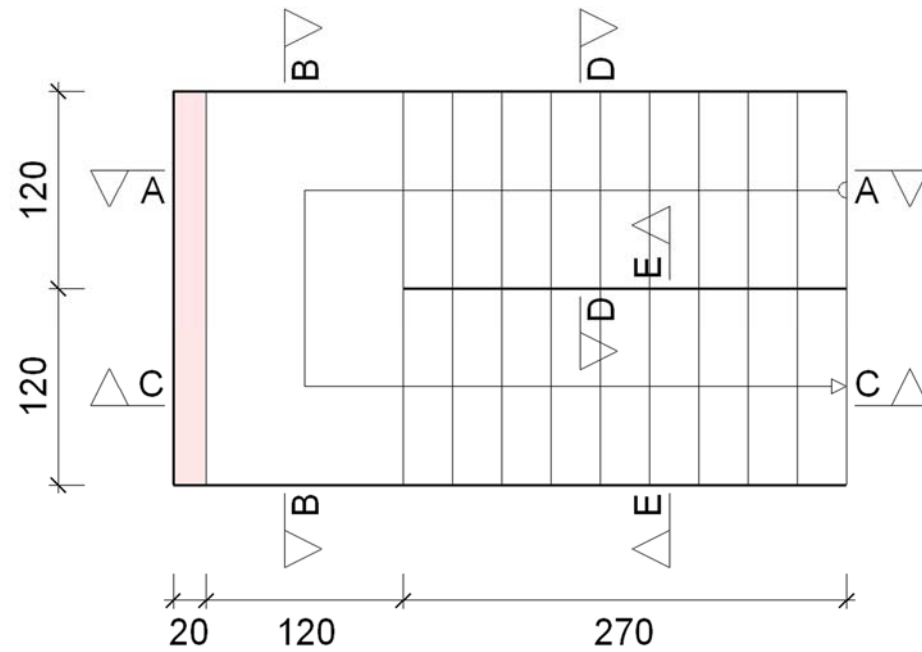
Escaleras de salida a la calle desde el aparcamiento. Fuente: Propia
